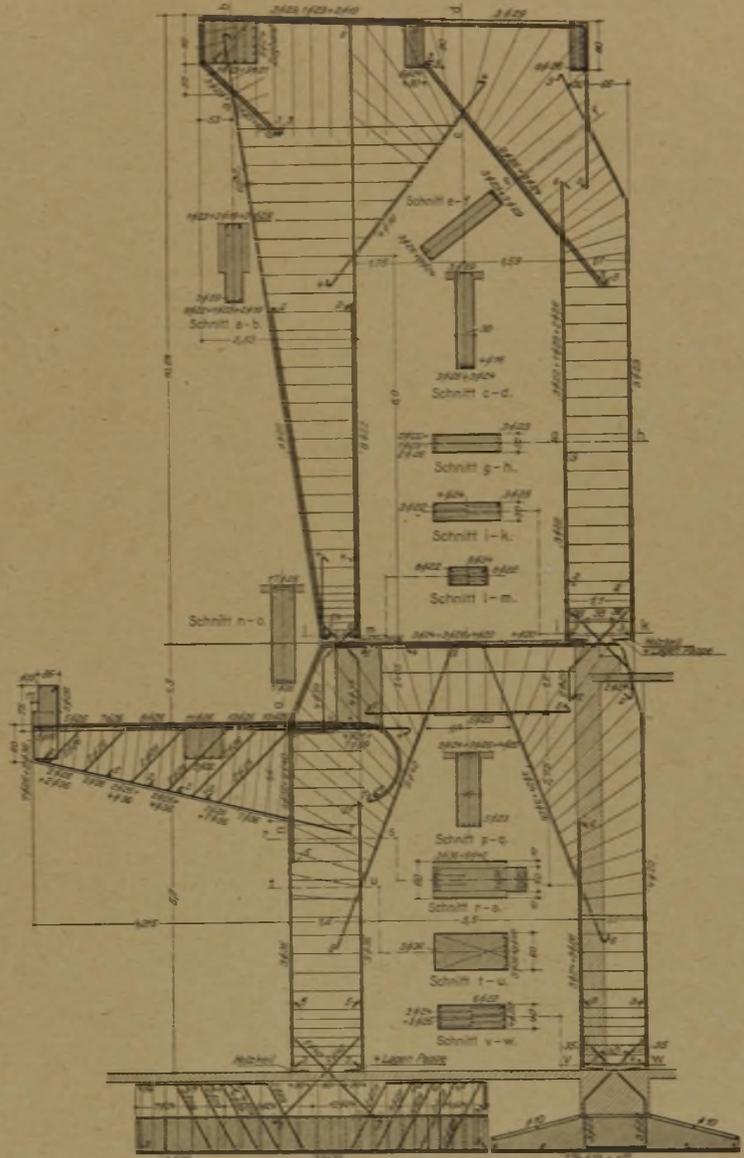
(rechts). Bewehrung der Portalkonstruktion (1 : 120).
